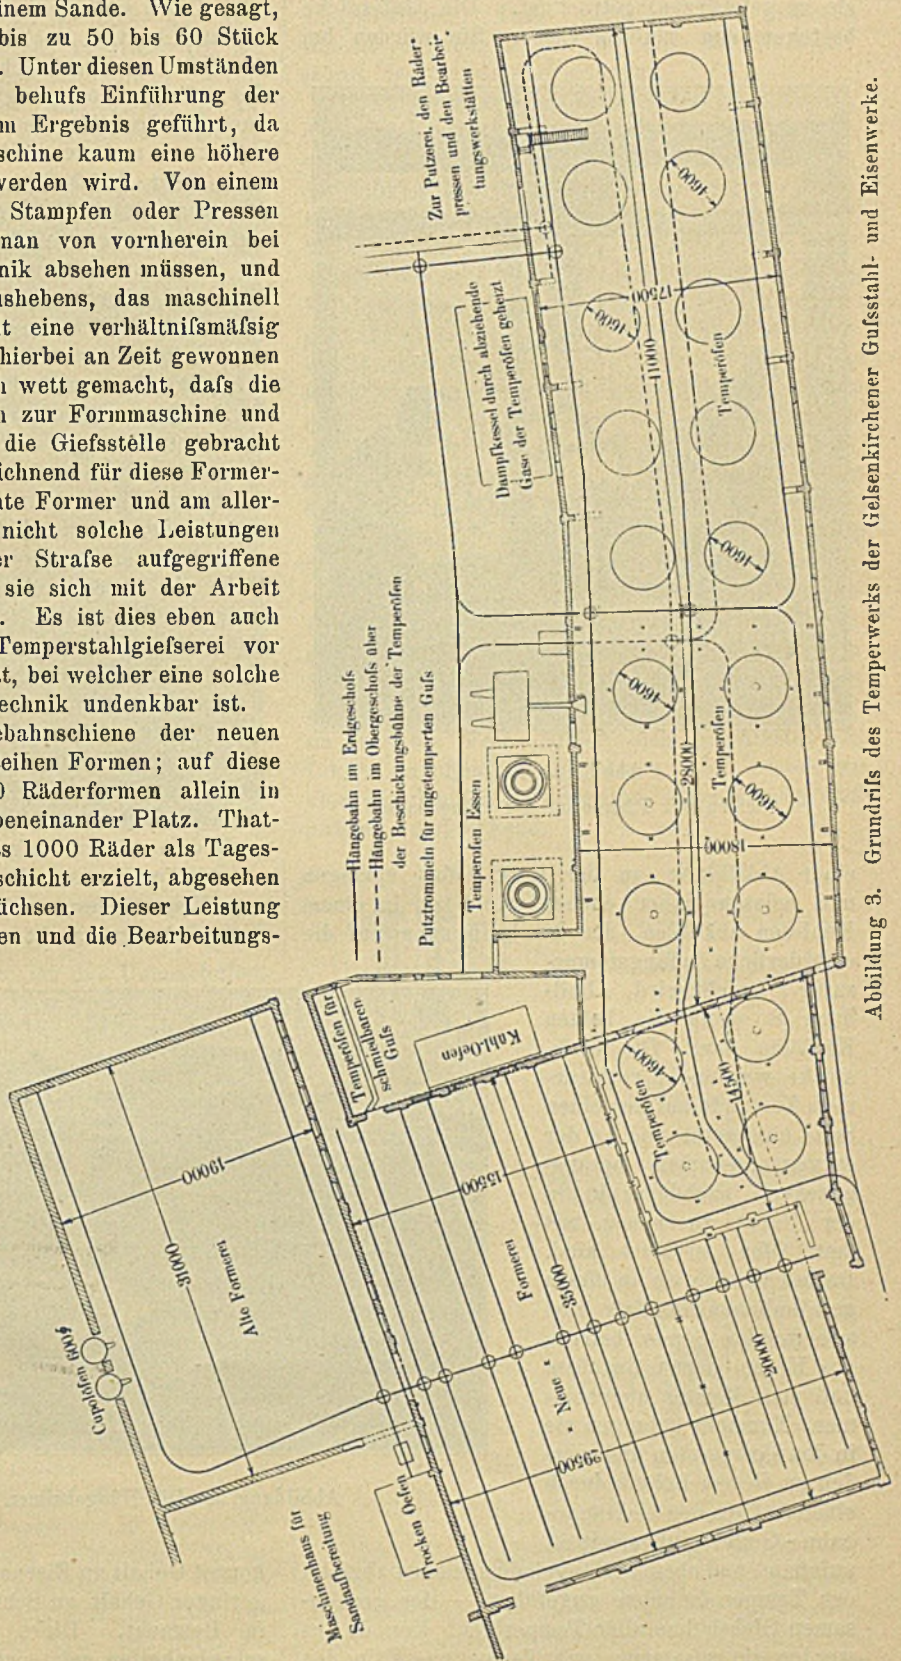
Grundriss des Temperwerks der Gelsenkirchener Gussstahl- und Eisenwerke.
